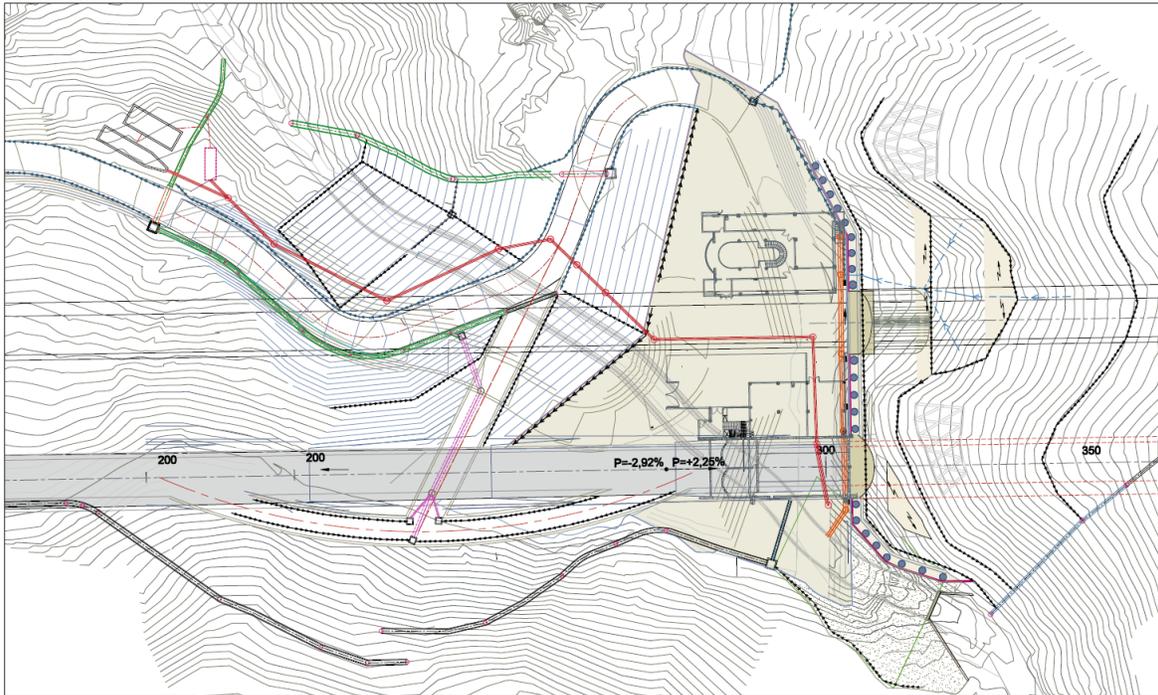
Detalle Plazoleta Portal Occidental Túnel Santa Elena
